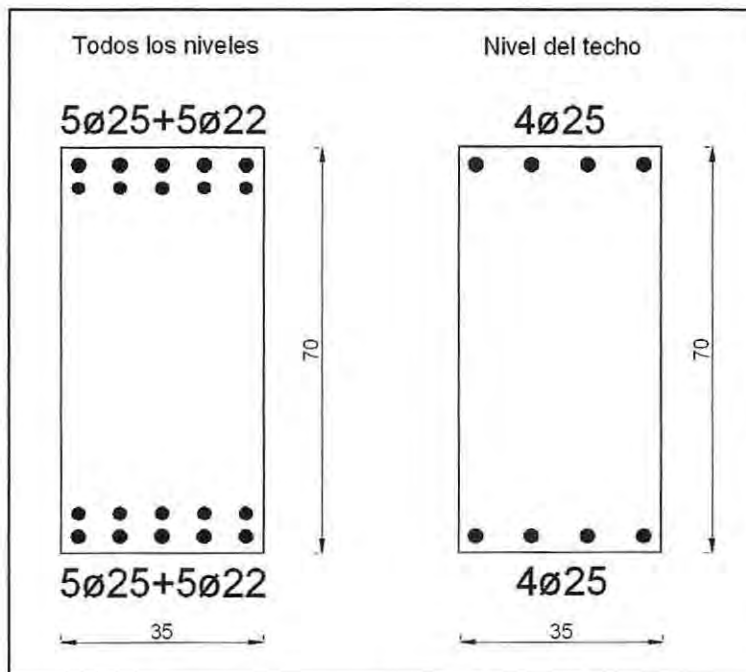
Disposición del refuerzo longitudinal en vigas.
